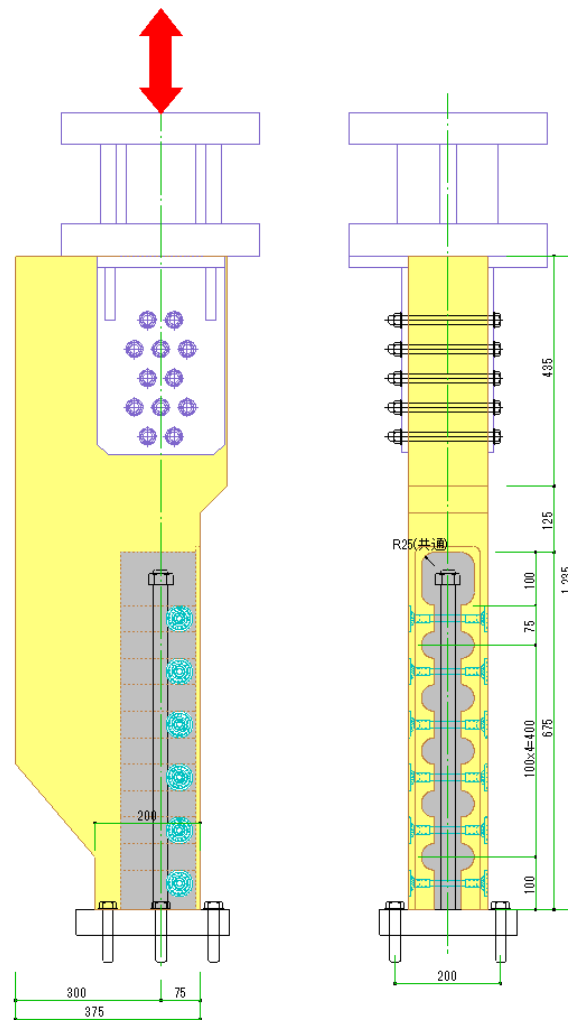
TCGB-SB6k 試験体の詳細 (mm)
